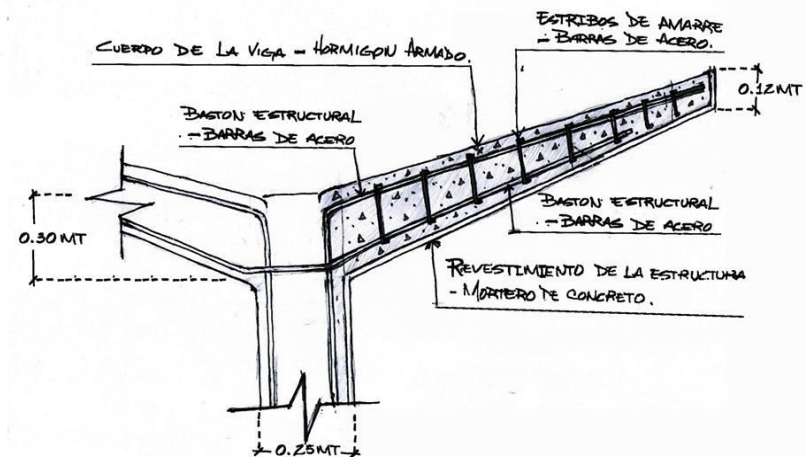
Detalle de armado de paraboloides. Elaboración Propia
